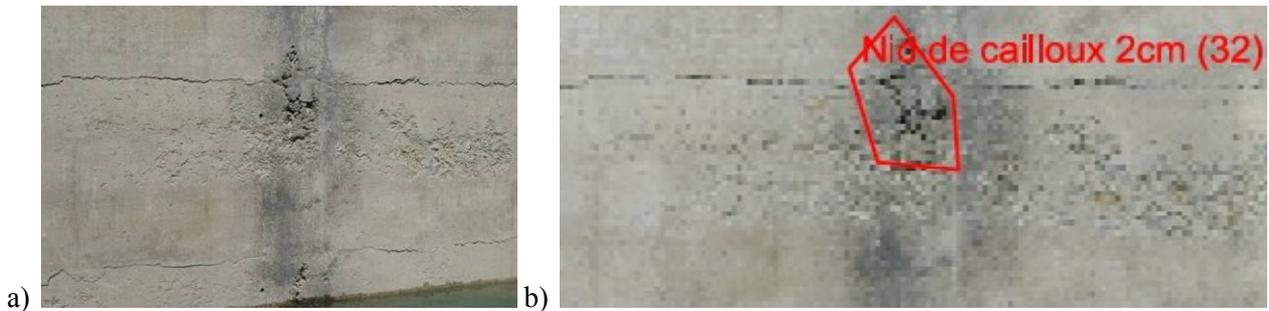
a) Photo brute b) Zoom sur extrait de plan PDF avec détection automatique du défaut et texture de fond
